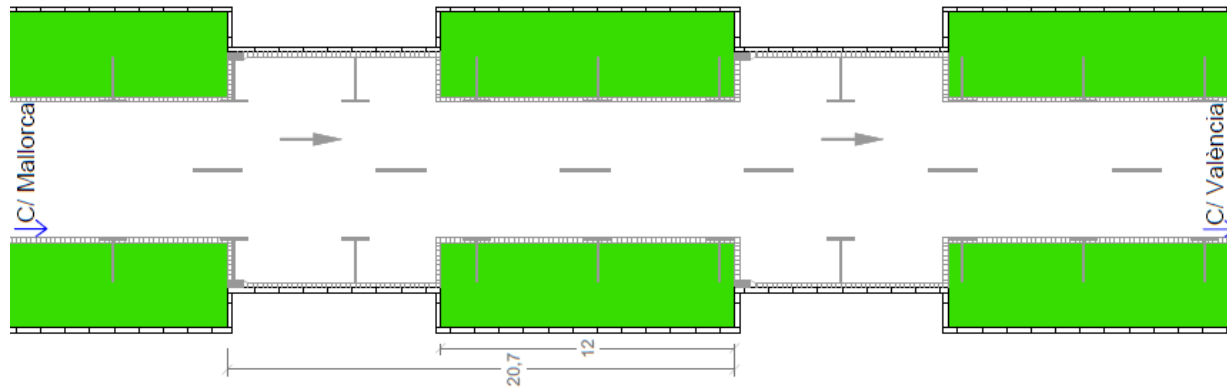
Planta de la propuesta para la C/ Lepanto, caso c) (Tipo 2).
